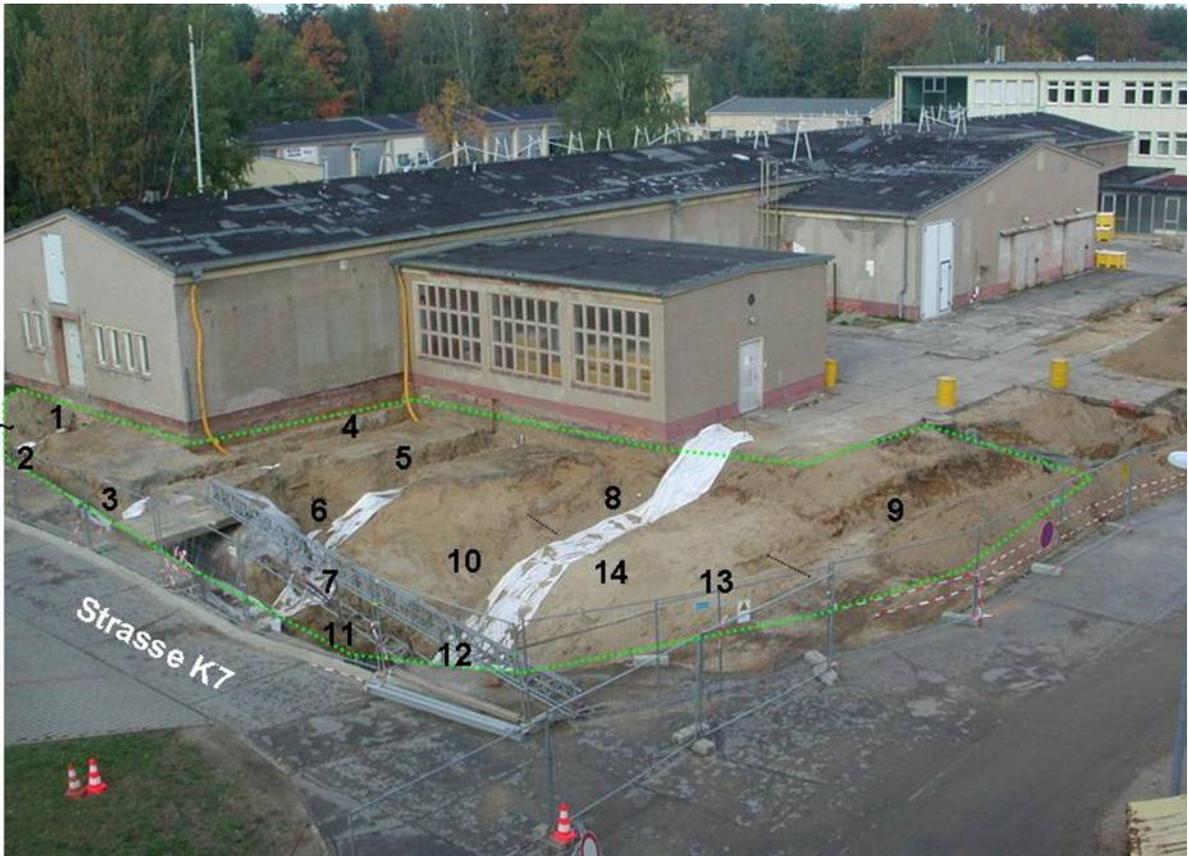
Teilbereich 1 der Hofflächen des Geb. 8d nach der Sanierung mit Probenahmebereichen (Rückbaukomplex 2)
